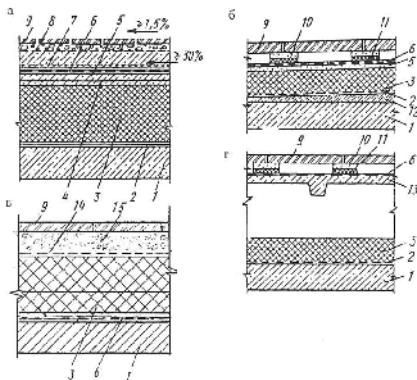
Конструкции эксплуатируемых крыш: а - бесчердачной, совмещенной с дренирующим слоем, б - то же, без дренирующего слоя, в - бесчердачной инверсионной, г - над холодным чердаком или с бесчердачной крышей инверсионного типа: 1 - несущая плита, 2 - паронепроницаемый слой, 3 - утеплитель, 4 - выравнивающий слой, 5 - грунтовка битумной эмульсией, 6 - рулонный гидроизоляционный ковер, 7 - мастика с противной гербицидами, 8 - дренажный слой, 9 - плиты пола, 10 - бетонная подкладка, 11 - асфальтовый маж, 12 - отмостка по уклону, 13 - кровельная панель, 14 - фильтрующий слой из синтетического холста, 15 - балластный и дренирующий слой гравия
